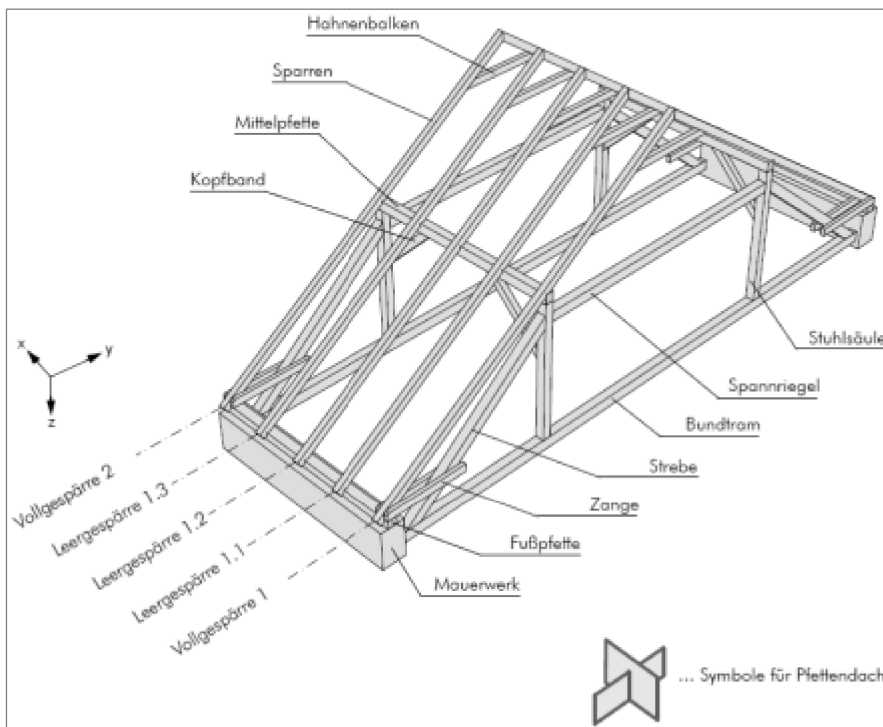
Pfettendach mit zweifachem Hängewerk¹⁰²
